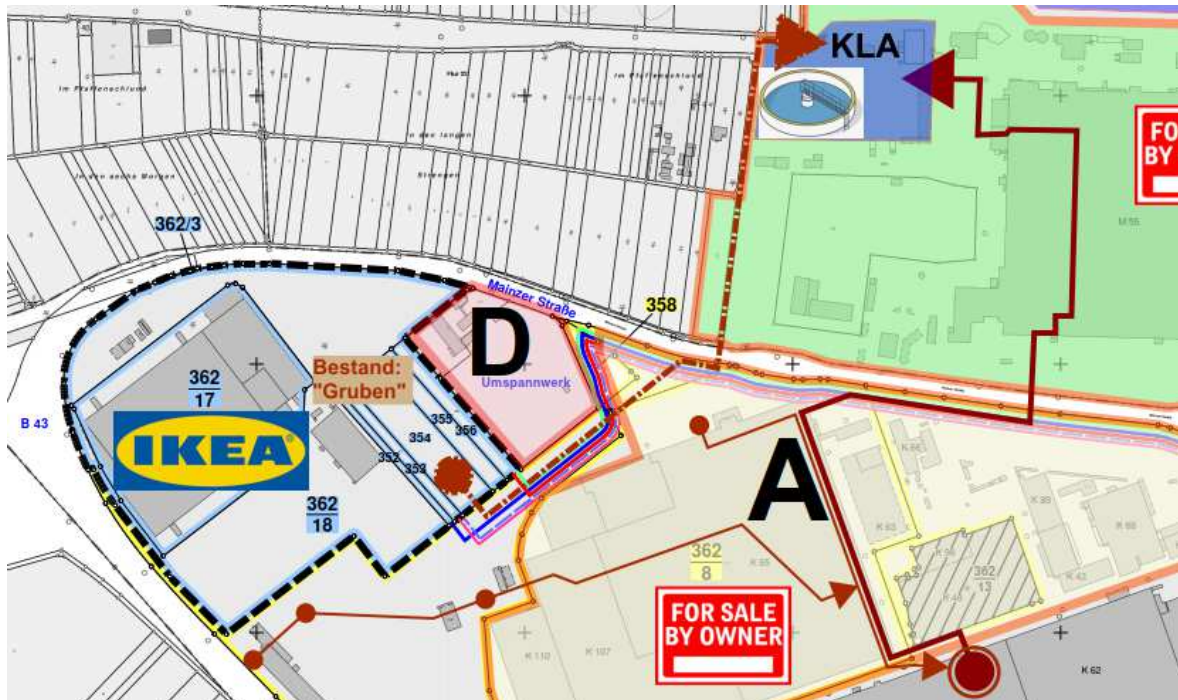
Lageplanausschnitt, Schmutzwasser Fließweg (Bereich der geplanten Trasse, vgl. Anhang A-06)
